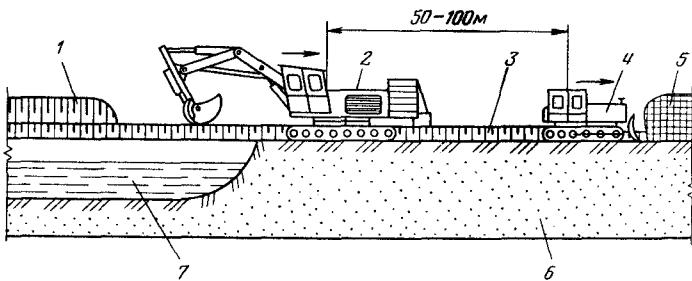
Схема разработки траншеи экскаватором с предварительным выгортыванием:
